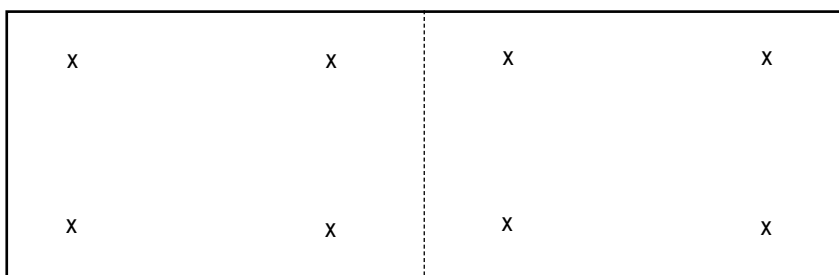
Plaatsing bevestigers voor mechanisch bevestigde platen
